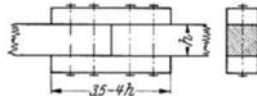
Stoß der Schwelle eines Lehrgerüsts.
